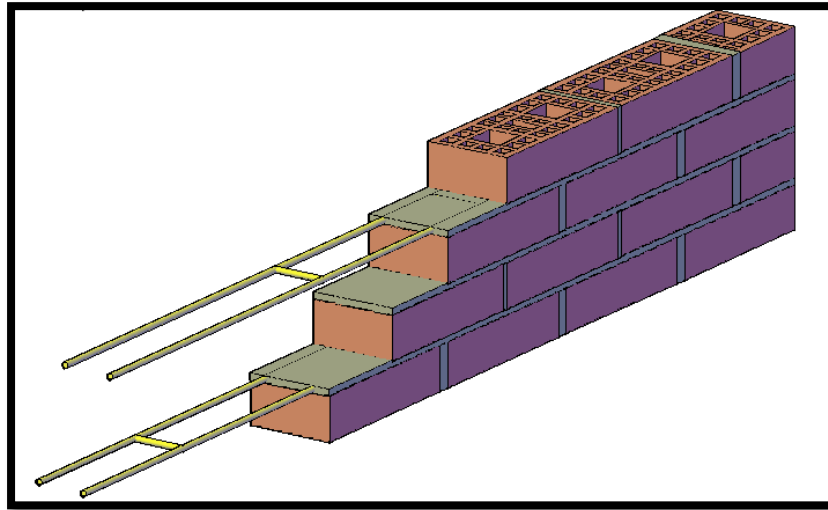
Bosquejo muro de albañilería con escalera Acma
